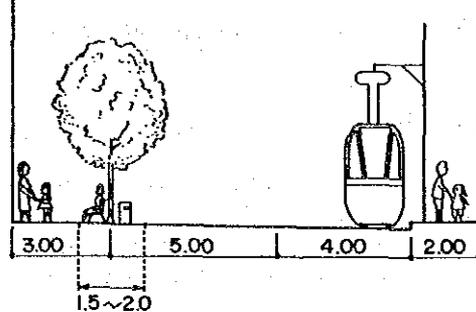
SECCION TRANSVERSAL DE CALLE PALMA
